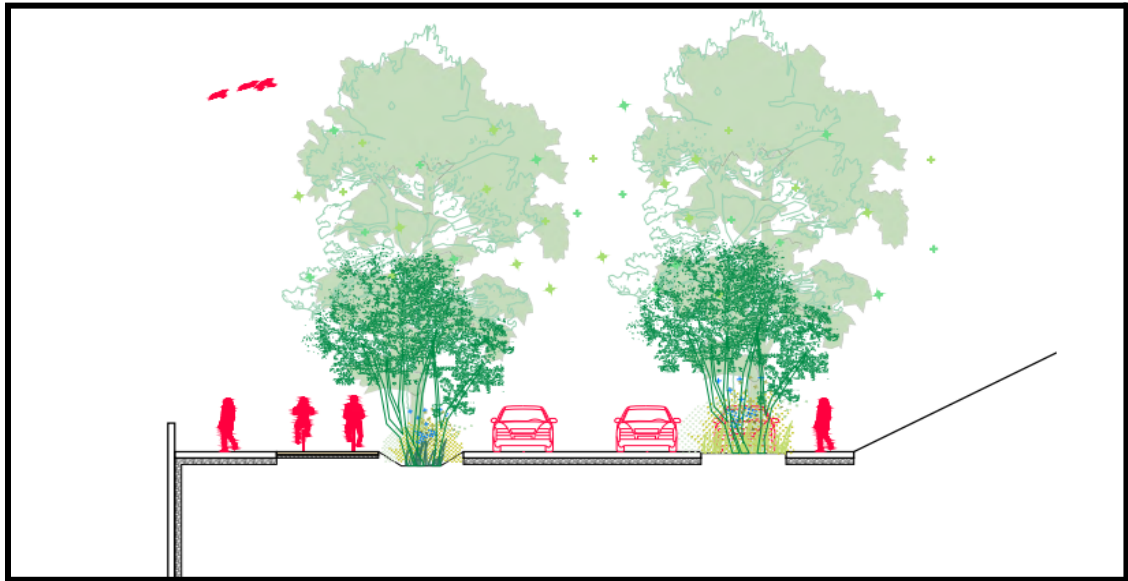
Coupe sur le boulevard urbain (Source : Agence TER)
